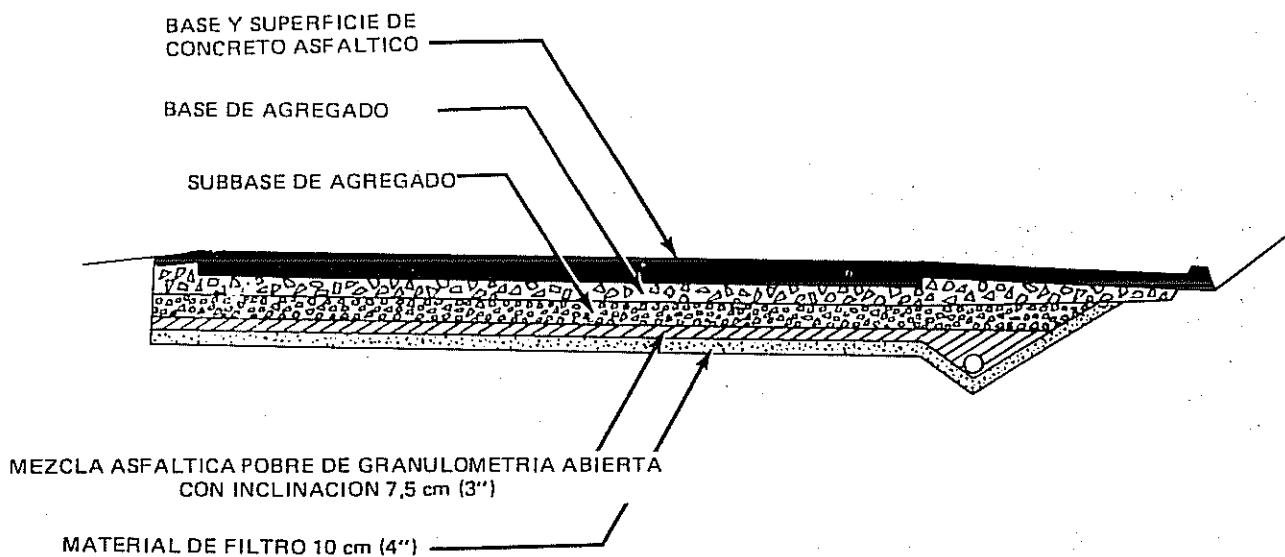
Sección transversal mostrando un sistema de drenaje bicapa que utiliza mezcla asfáltica de granulometría abierta elaborada en planta
